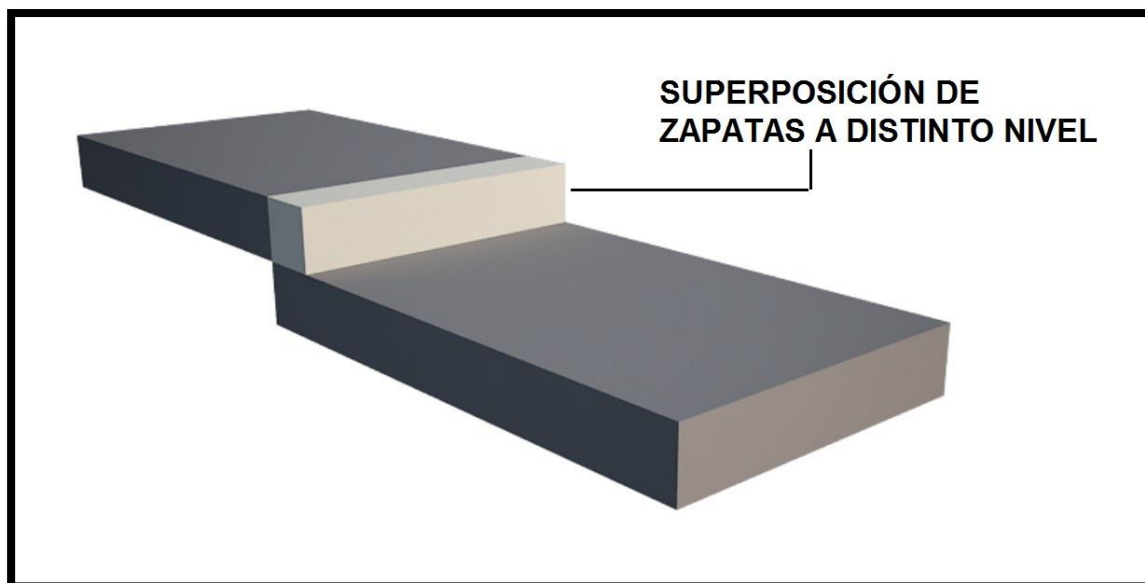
Esquema de encuentro de zapatas de fundación de distintos niveles ejecutados.
